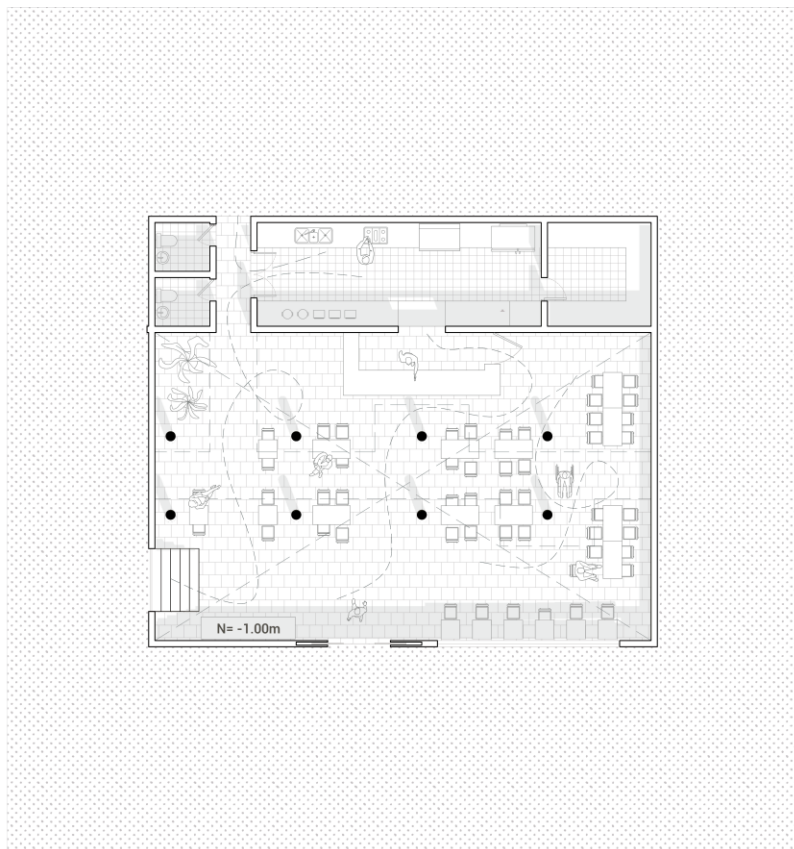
Planta pizzería. Ampliación. Elaboración propia
